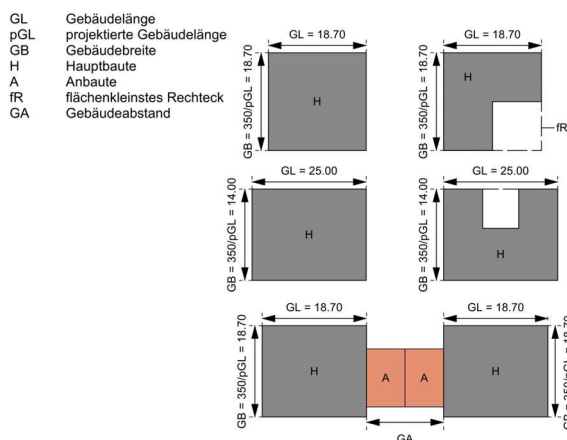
Flächenkleinstes Rechteck für Gebäudelänge und -breite über gestaltetem Terrain (Bsp. Wohnzone W11)
